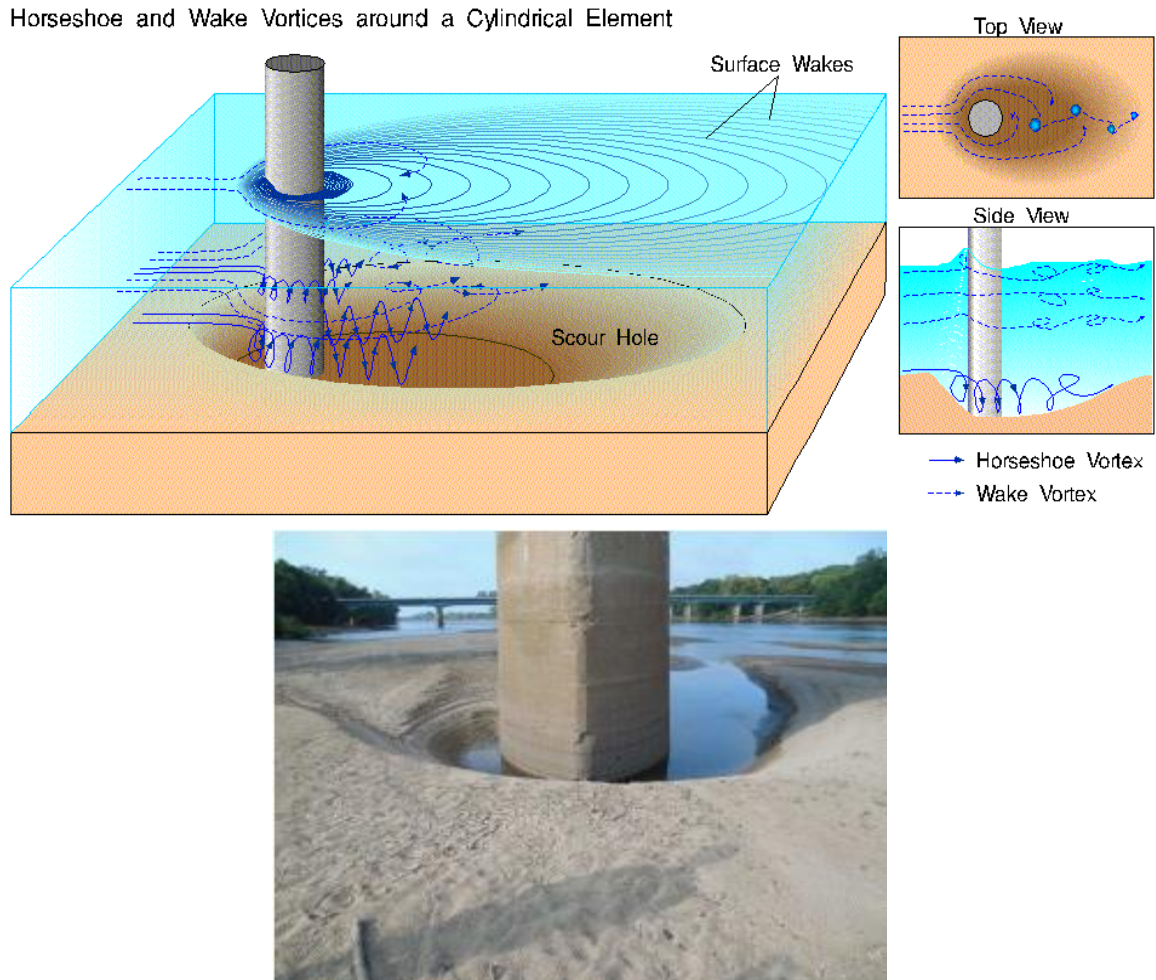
(a) Illustration d'affouillement au pied d'une pile de pont¹⁶, (b) Affouillement autour d'une pile¹⁷
